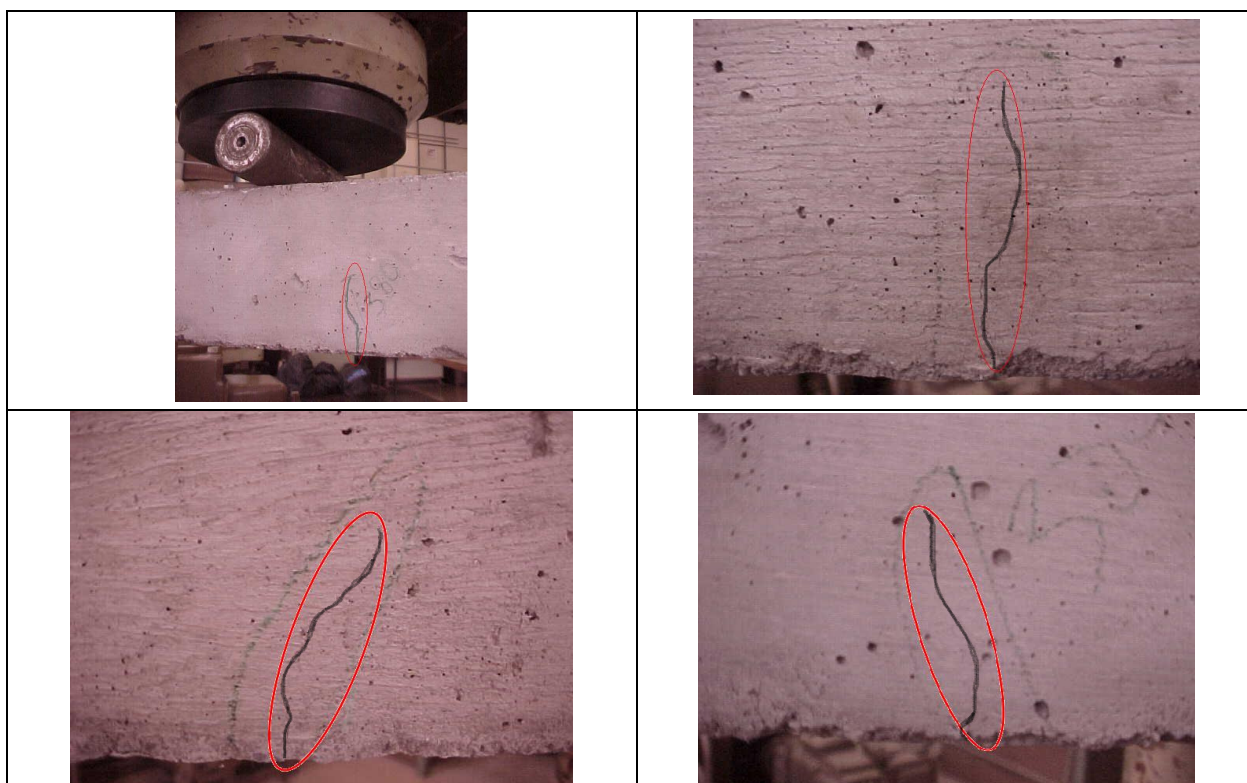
Aberturas de fissuras nos prismas sob carregamento central de curta duração.
